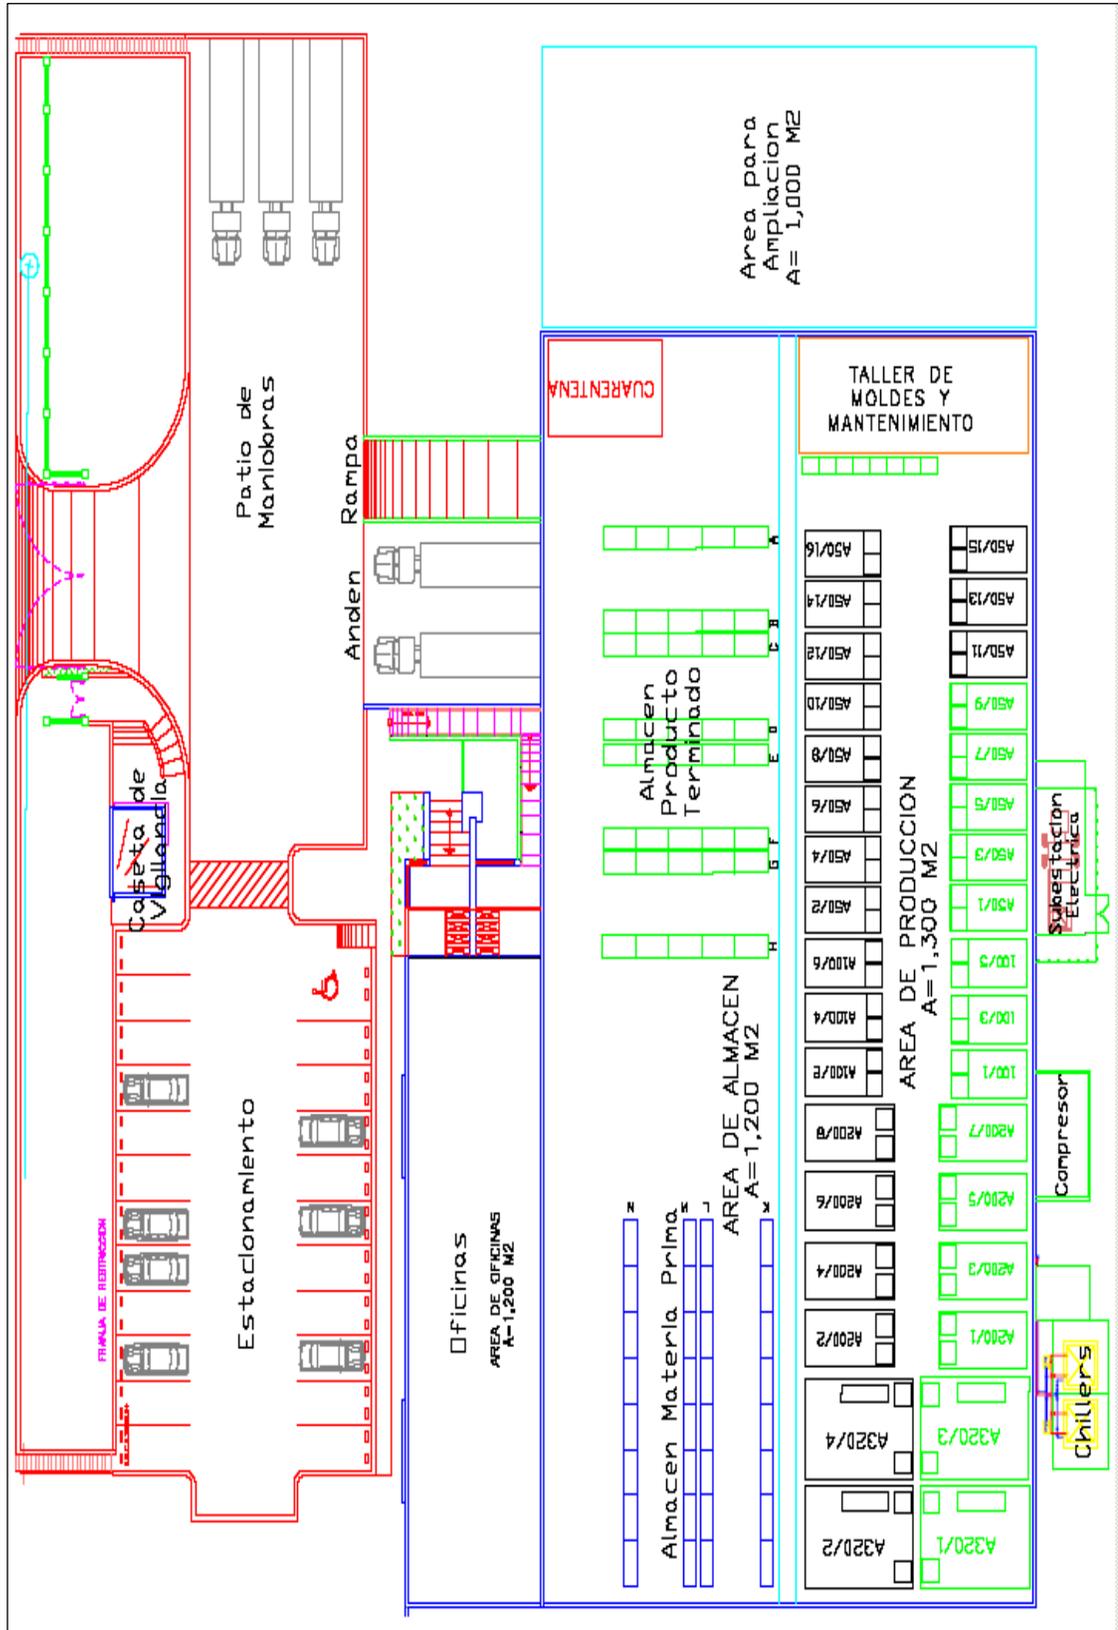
Distribución de planta nueva. Fuente: Elaboración propia
